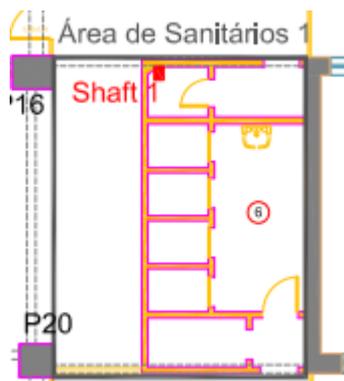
Planta de demolição –sanitário existente (2ºpavimento)
